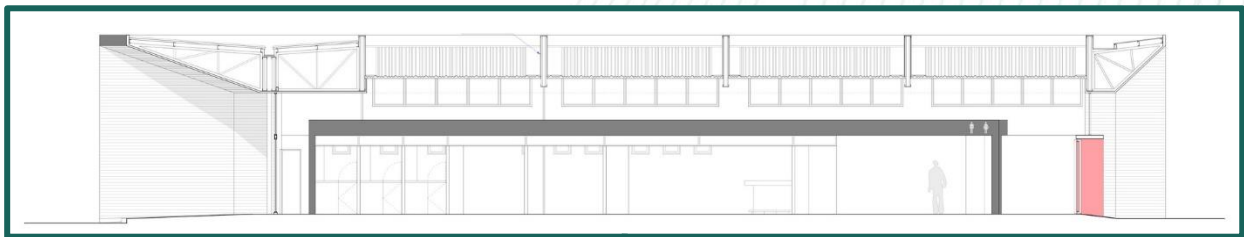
Sección transversal - Fuente: TNG Arquitectos
